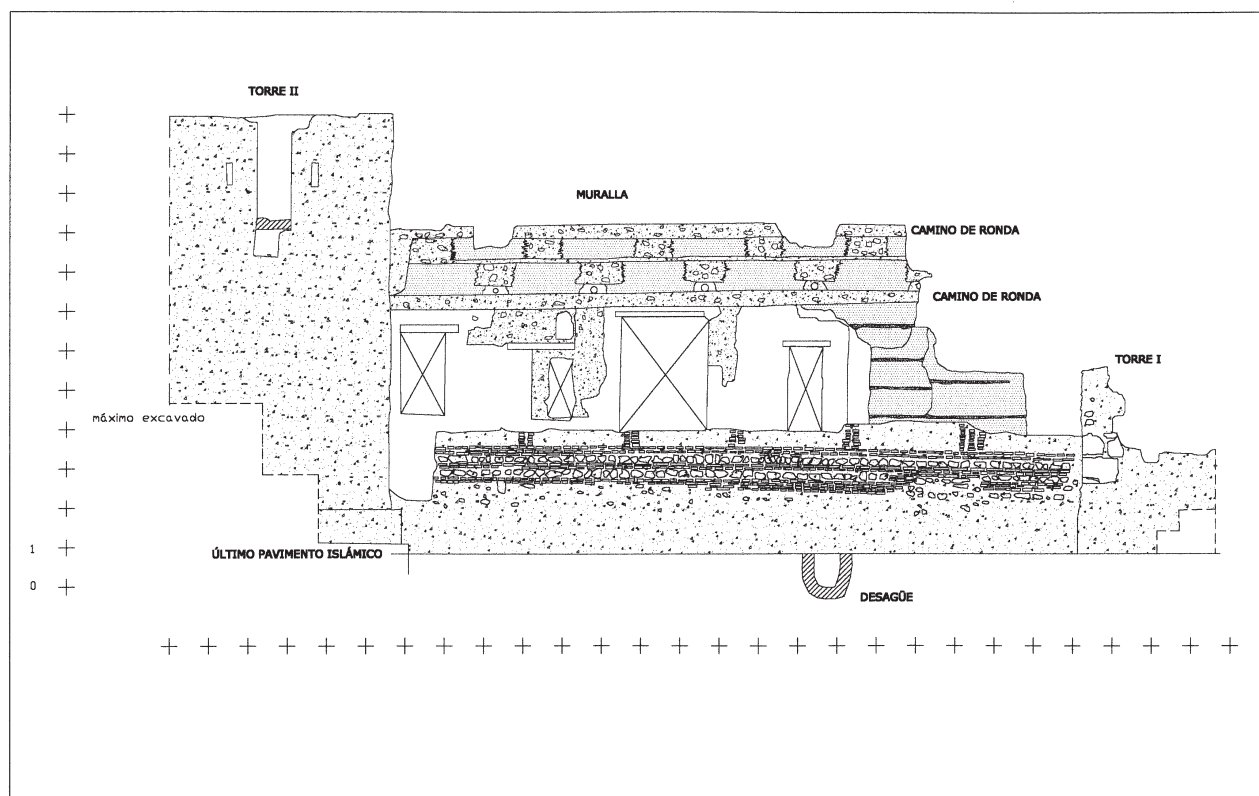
Excavación en el antiguo convento de Verónicas: alzado de la muralla.
